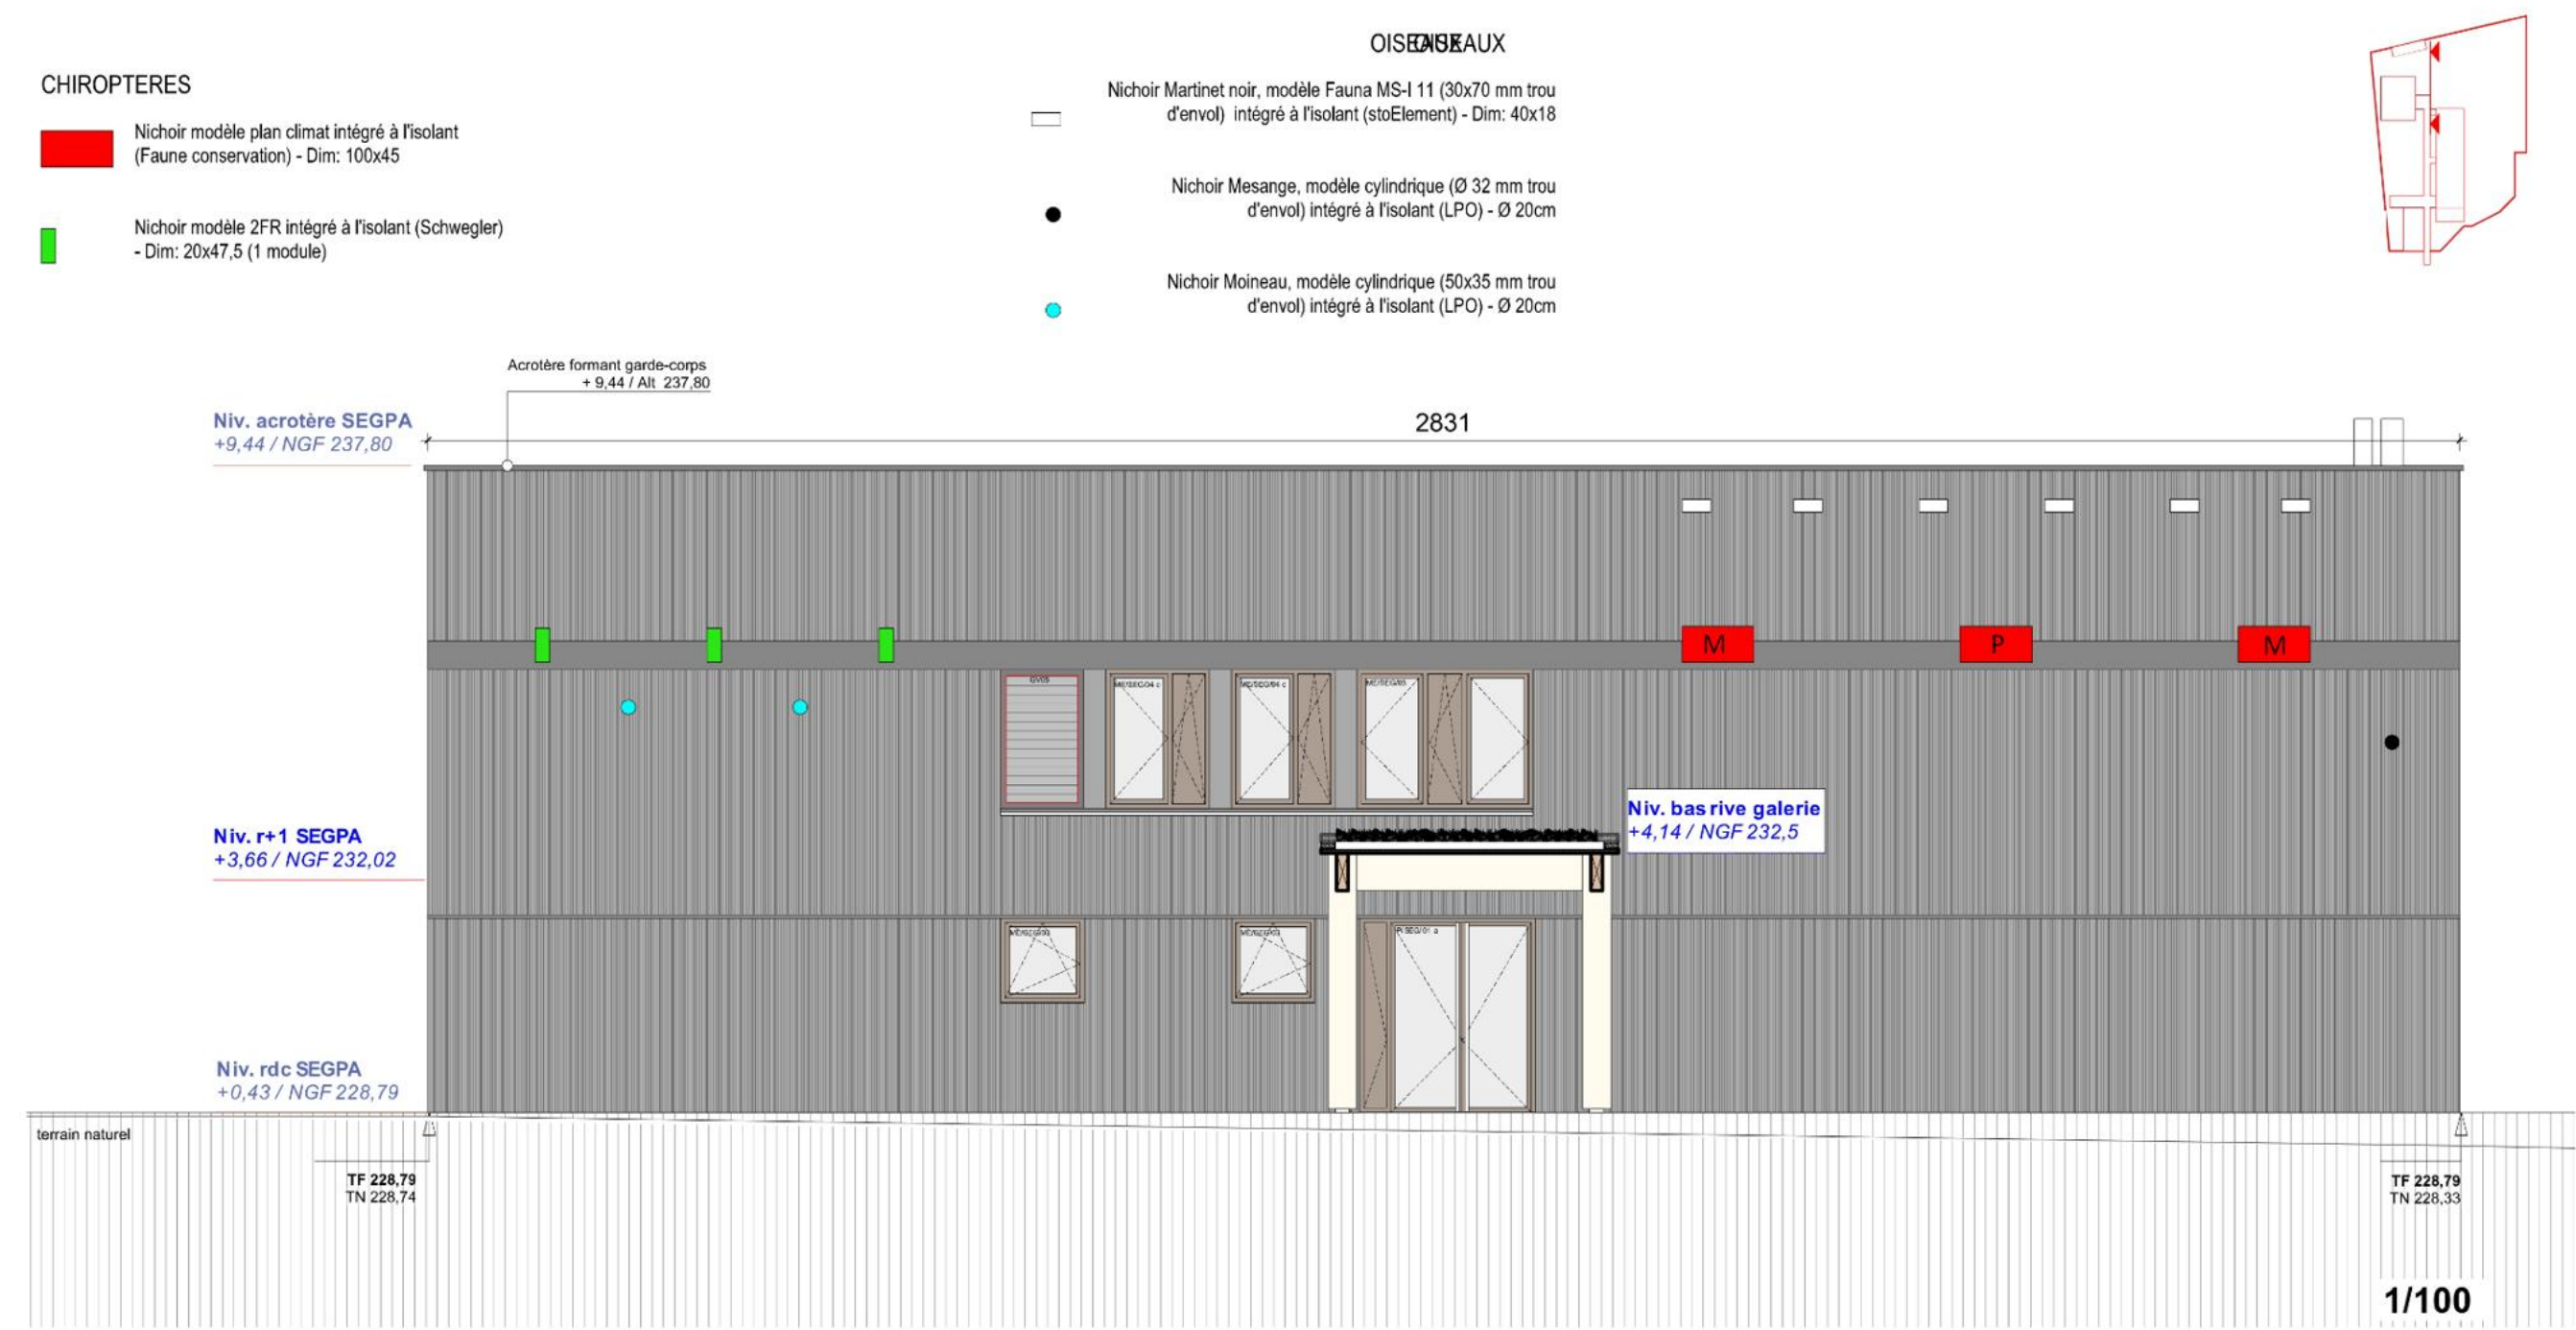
Localisation des gîtes compensatoires sur le bâtiment SEGPA - façade est
